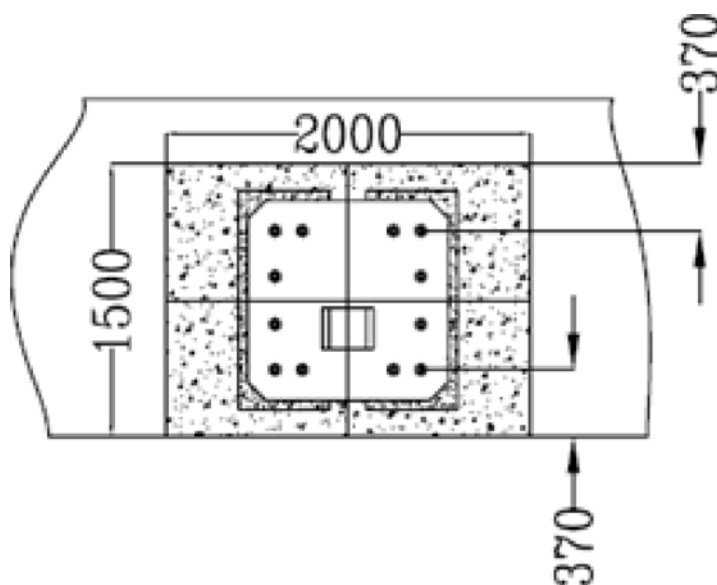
Dimensiuni pentru instalarea in beton
